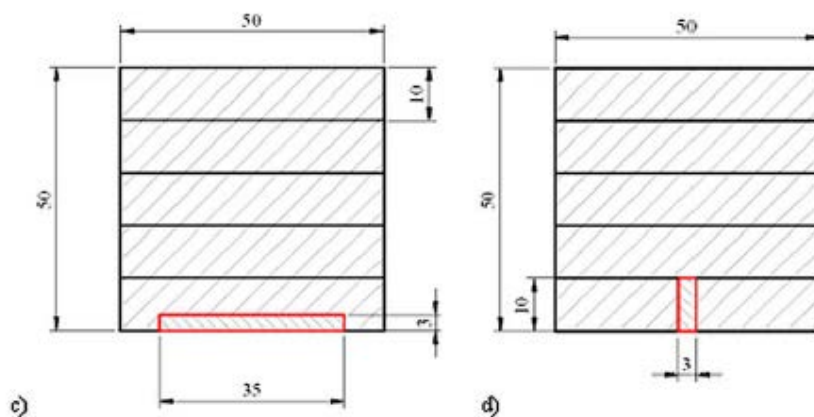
Disposición del refuerzo sobre la viga laminada (Fuente: Ribeiro et al. 2009).³¹⁷
